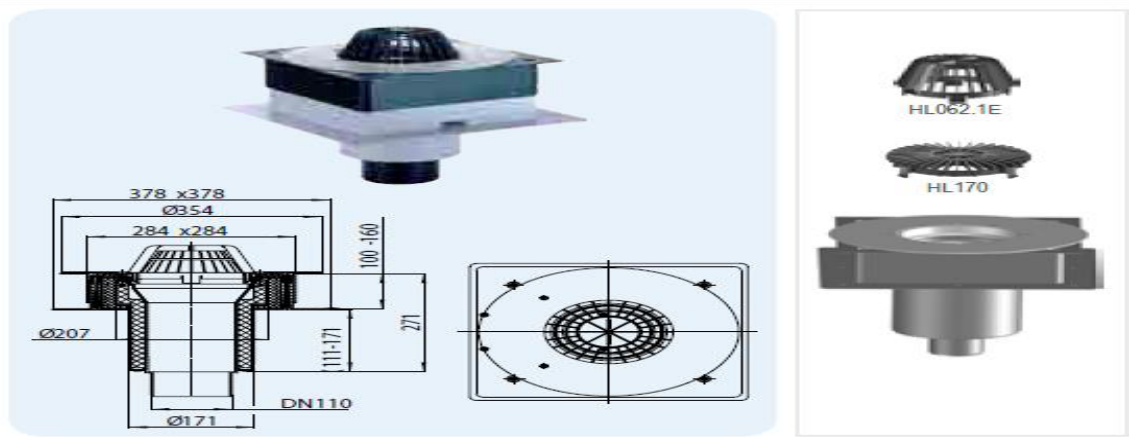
Загальний вигляд та креслення з розмірами воронки HL63P\1
